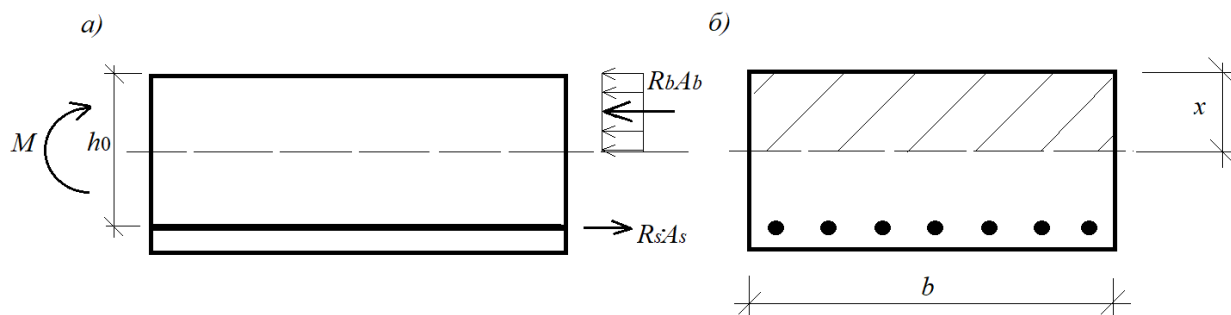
Расчетная схема железобетонной плиты: а) продольный фрагмент плиты перекрытия с односторонним армированием в растянутой зоне; б) поперечный фрагмент плиты перекрытия с односторонним армированием в растянутой зоне
